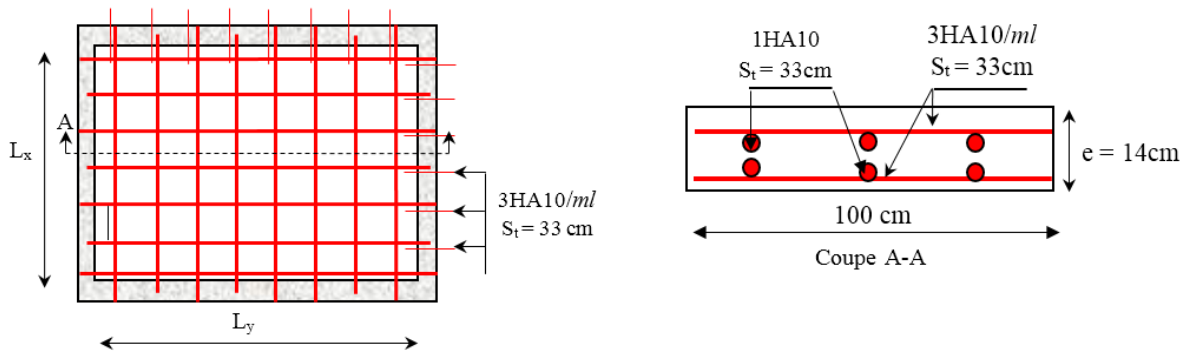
Schéma de ferrailage de la dalle avec ouverture
